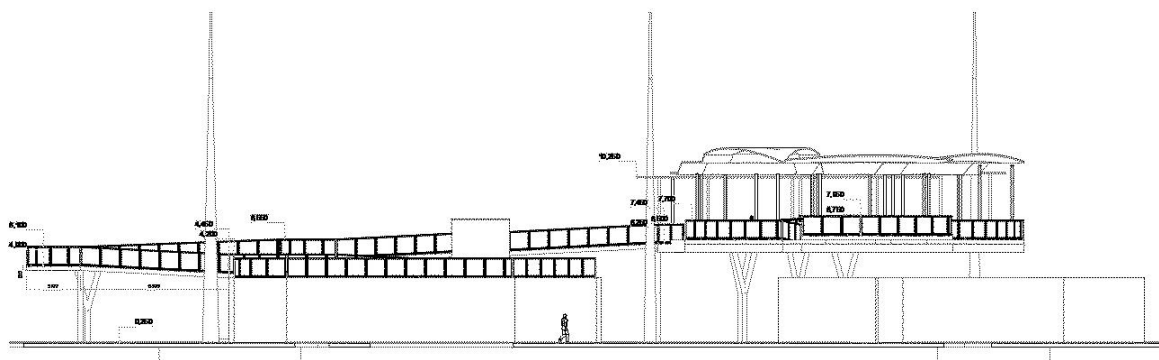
Фасад пешеходного моста. Фрагмент с пандусом со спуском на набережную
